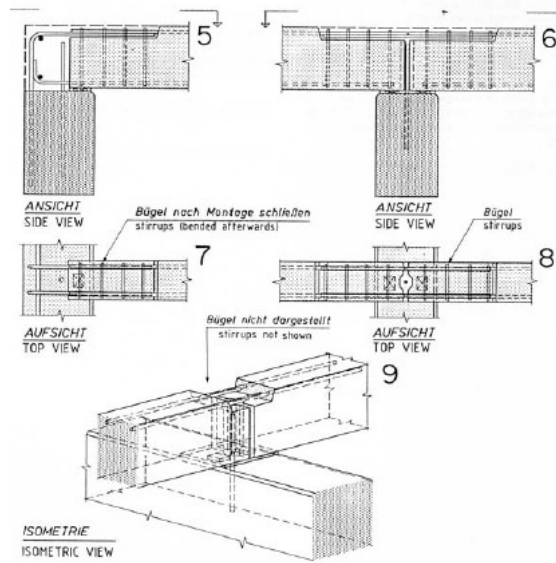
Ligação por barras de aço soldadas (Stupré, 1981)
